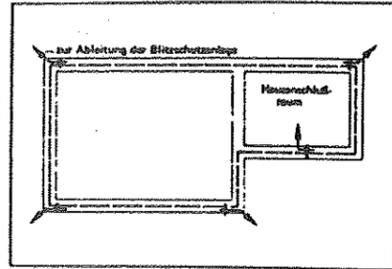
Anordnung des Fundamenterders mit Anschlußfahnen
